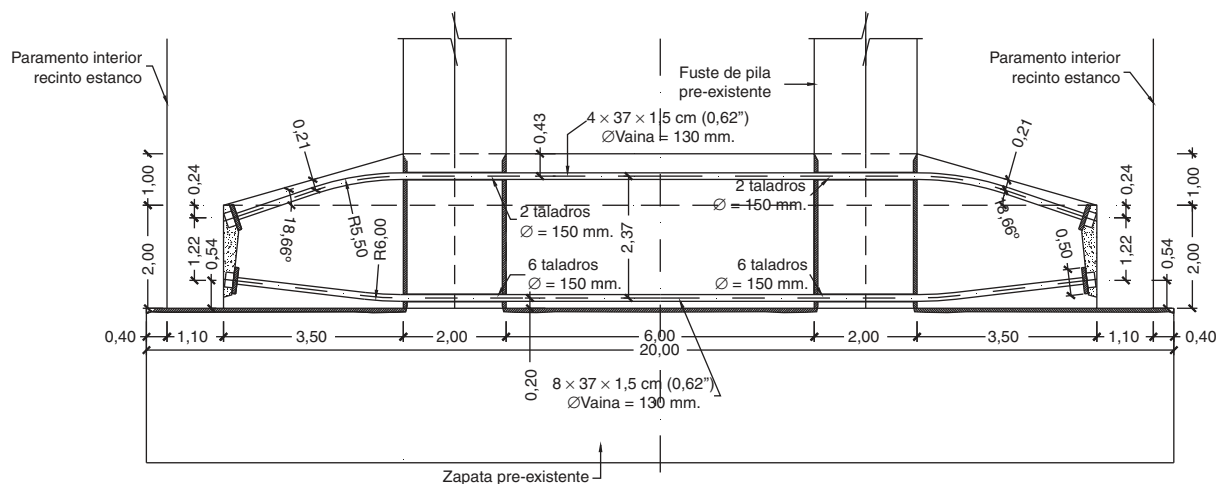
Alzado longitudinal del pretensado del recerido en pilas 1 y 4.
